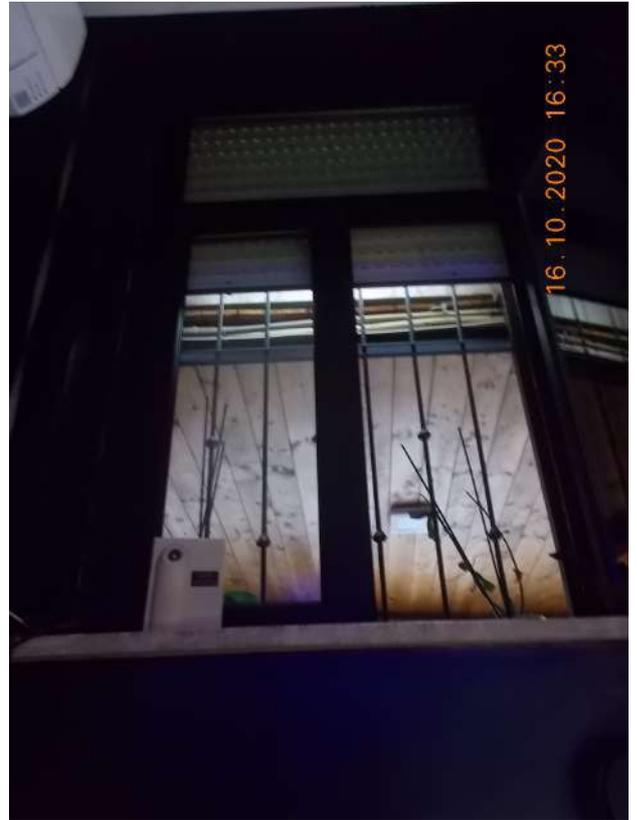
vista della zona antibagno e servizio igienico.
